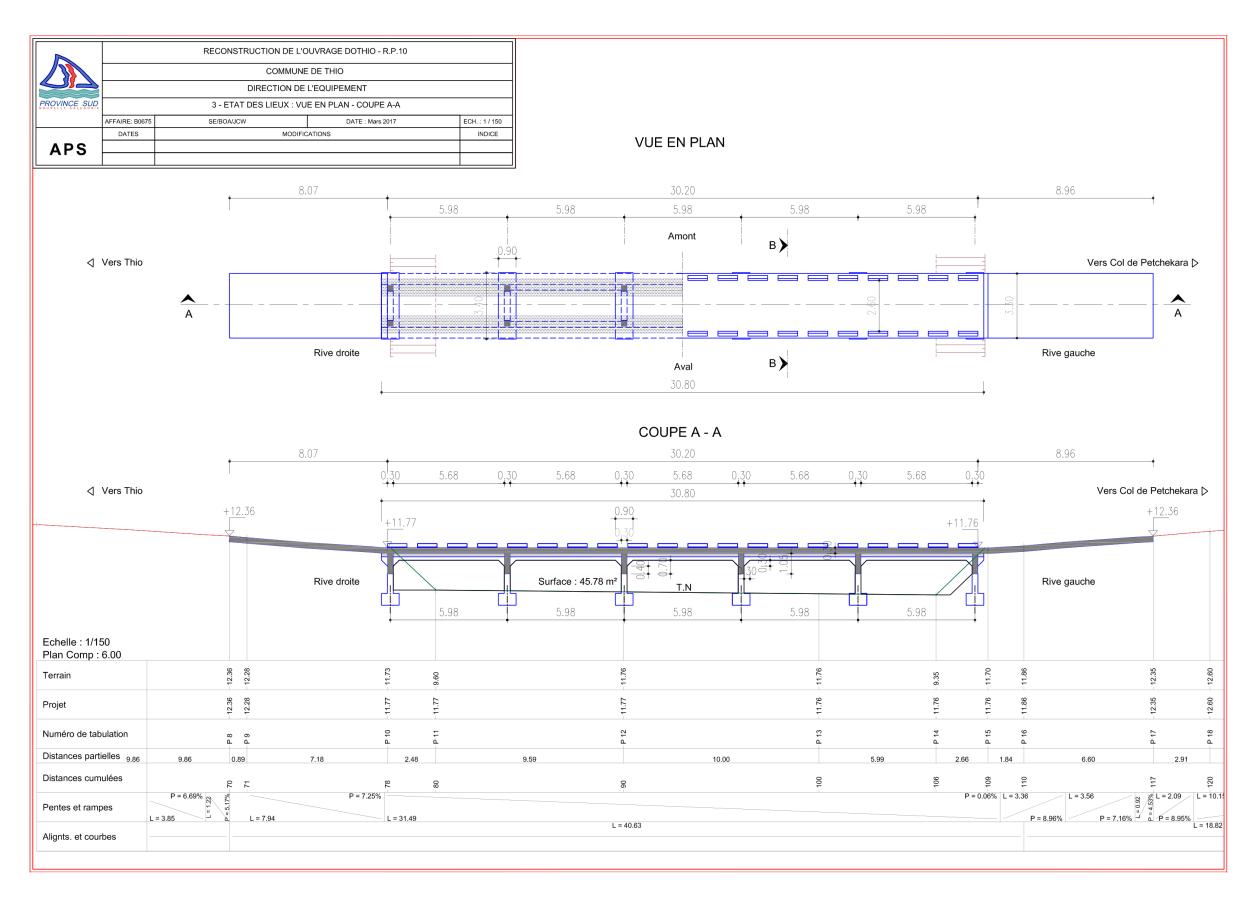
vue en plan de l'ouvrage Dothio actuel (source: DEPS, 2018).
